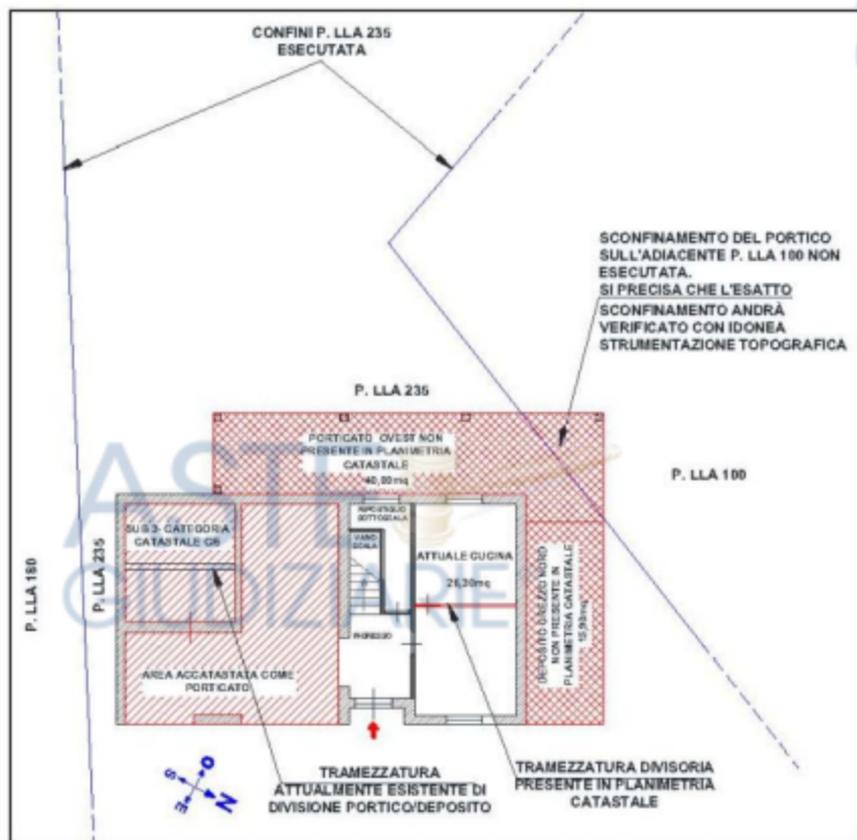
Planimetria del piano terra con individuazione delle difformità catastali
